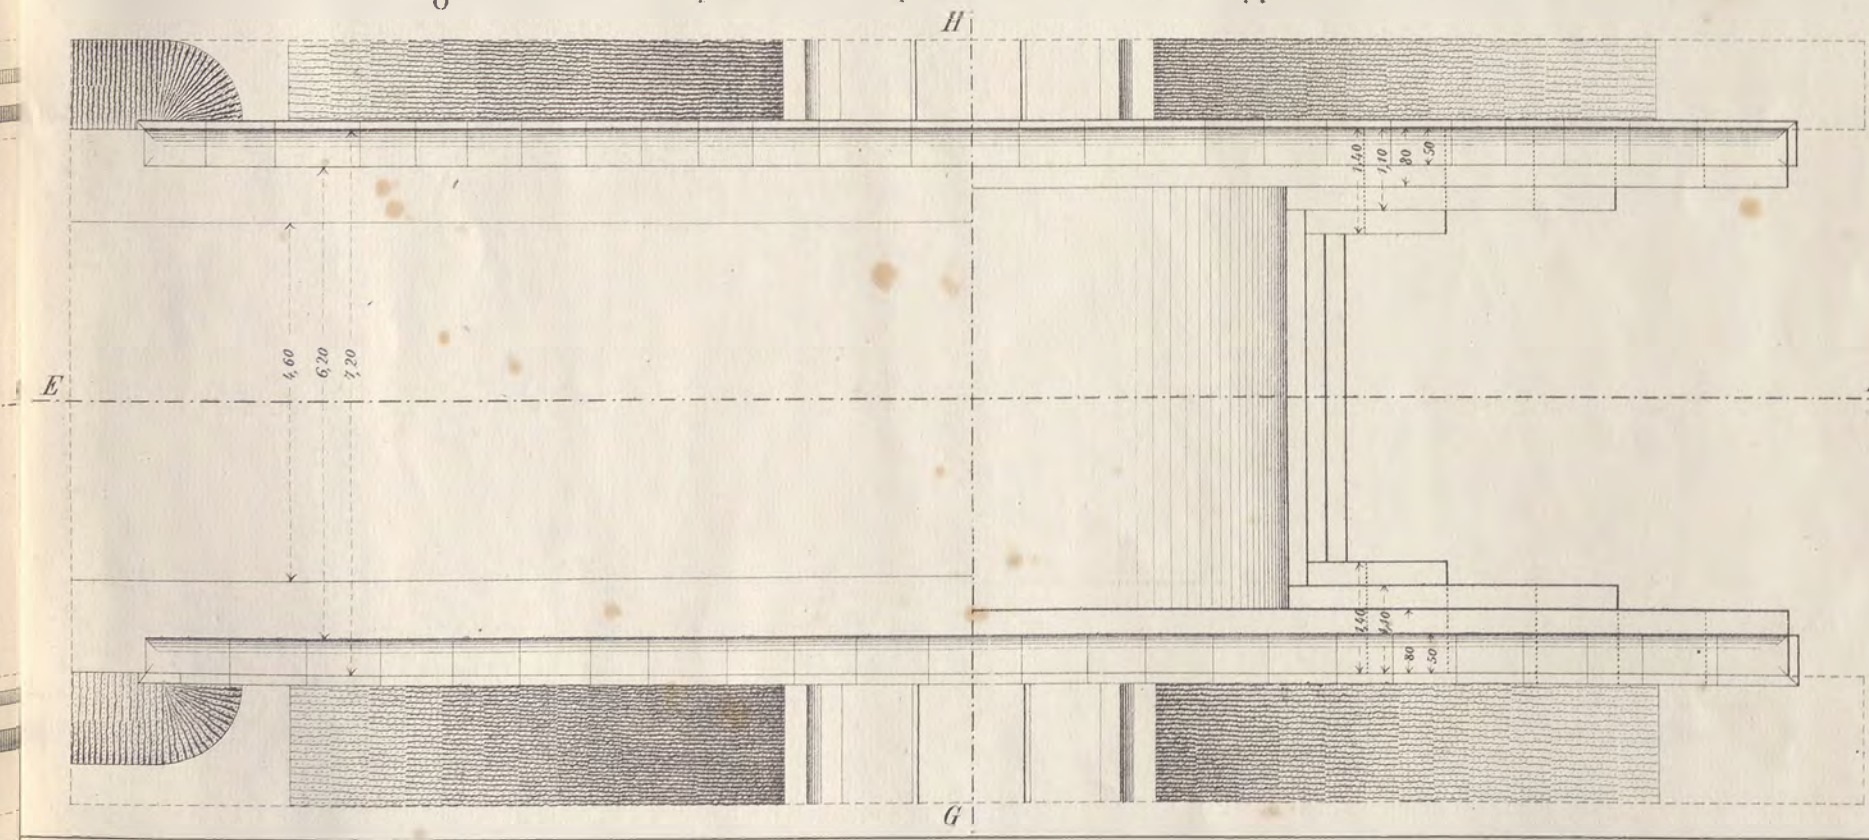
<sup>a</sup> Pianta ad opera finita e proiezione orizzontale supposto tolto il terreno.
